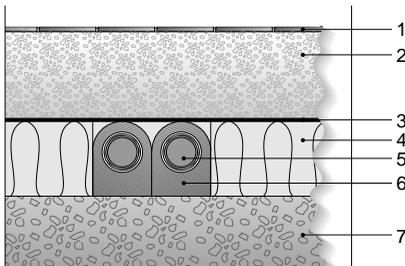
Leitungsverlegung auf der Rohbetondecke
